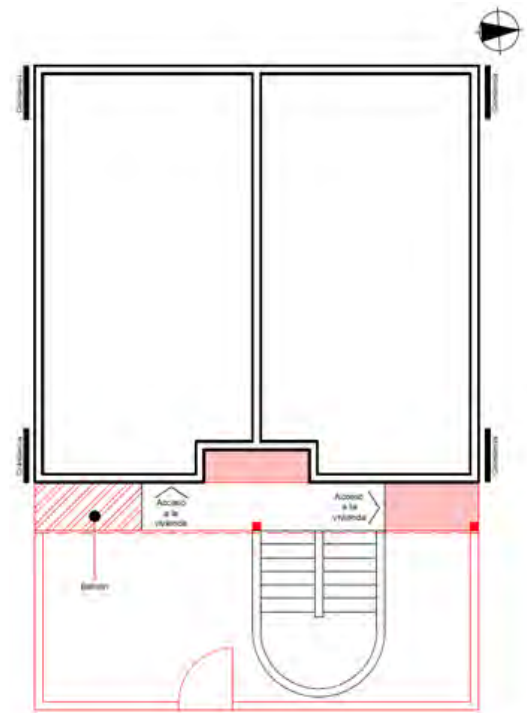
Planta del primer nivel del Edificio D indicando el área intervenida por modificación.
